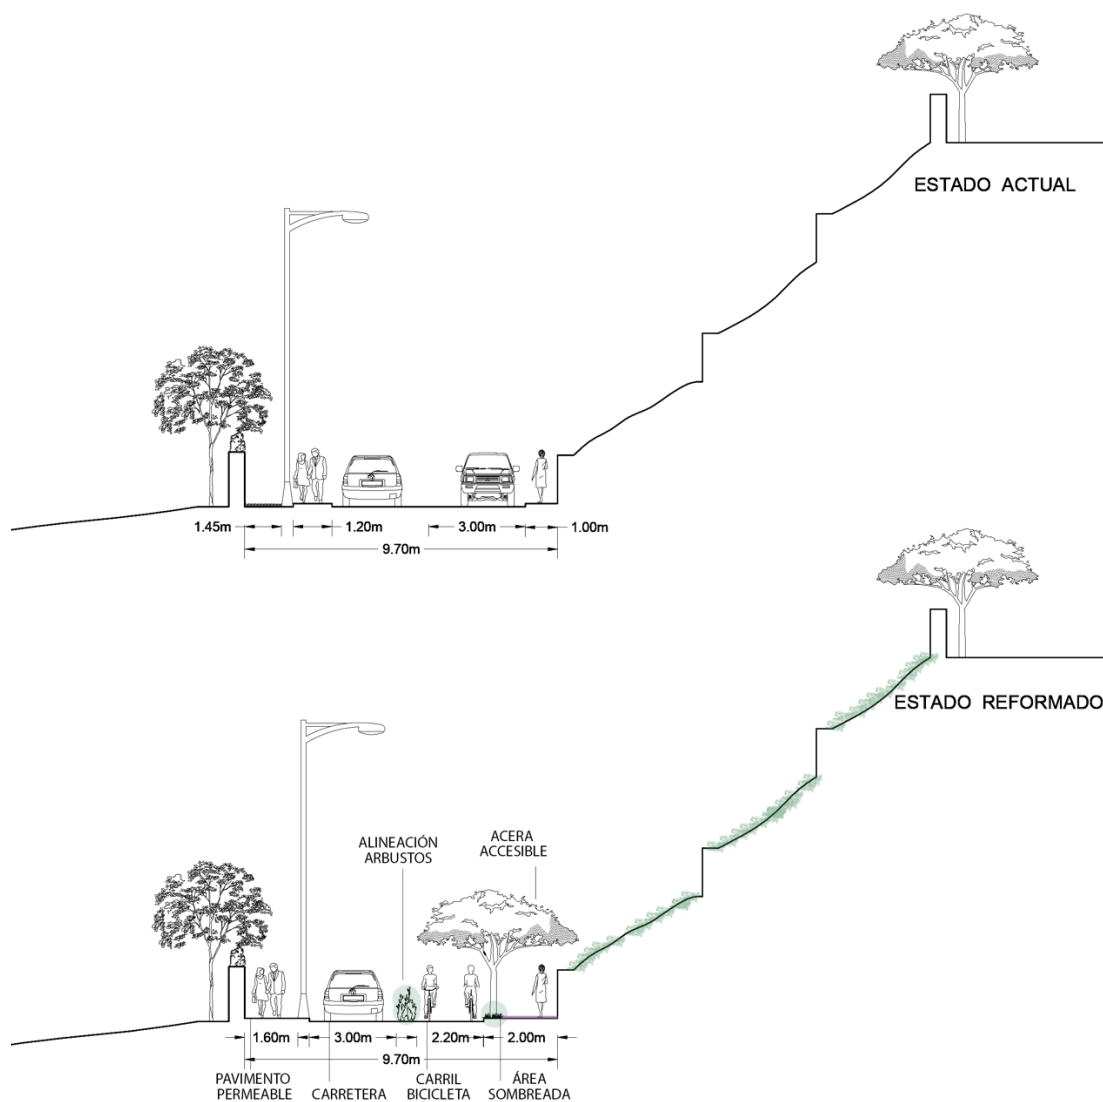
Plano de sección de la carretera Estación. Fuente: elaboración propia
